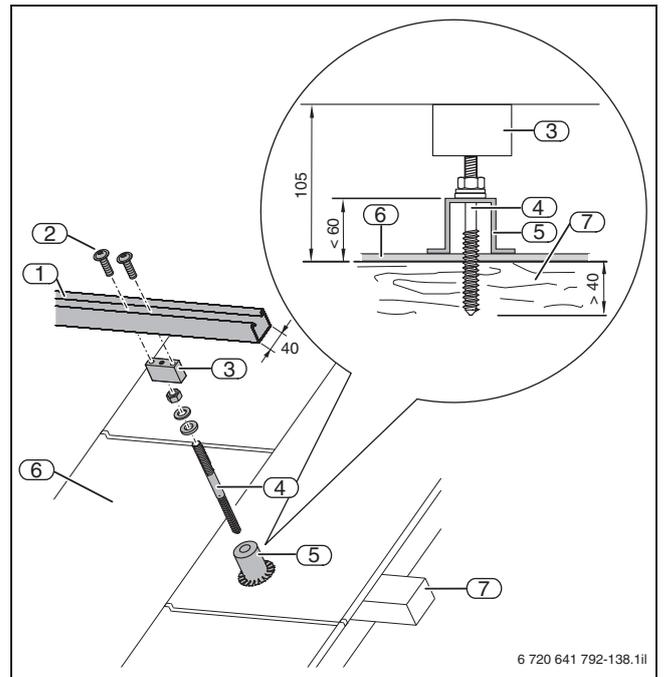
Fissaggio a carico del committente di boccole per il fissaggio a tenuta delle viti prigioniere in caso di montaggio sopra tetto su una copertura in lamiera (misure in mm)
